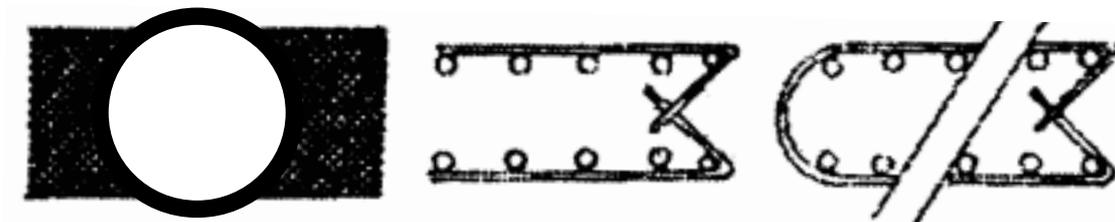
Junta circular y armado tipo (Vicente Ordura Vidal, 2015)
